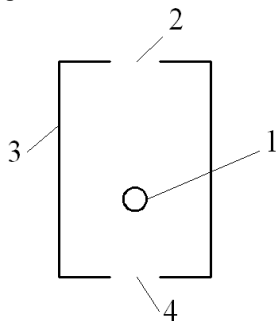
Принципиальная схема электроконвектора: 1- нагревательный элемент; 2-отверстие для выхода воздуха; 3-корпус; 4-отверстие для входа воздуха.
